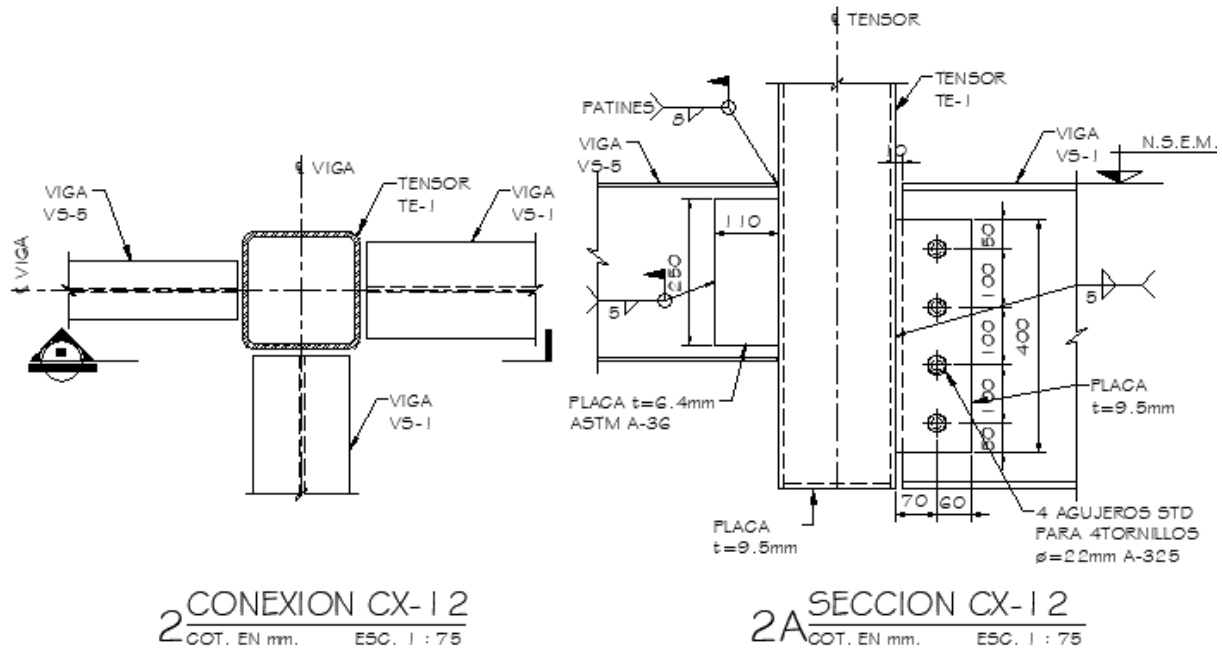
Elevación de conexión a columna usada por el Grupo BAYSA S.A. de C.V.
